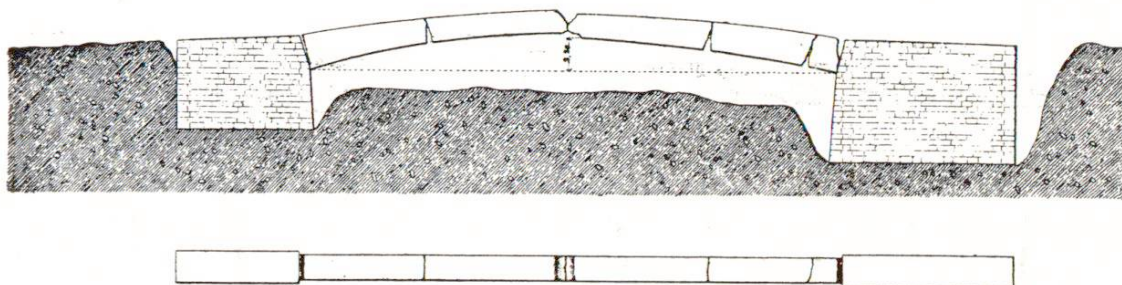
Elévation et plan de la voûte au moment où le voussoir de clef était entièrement détruit
